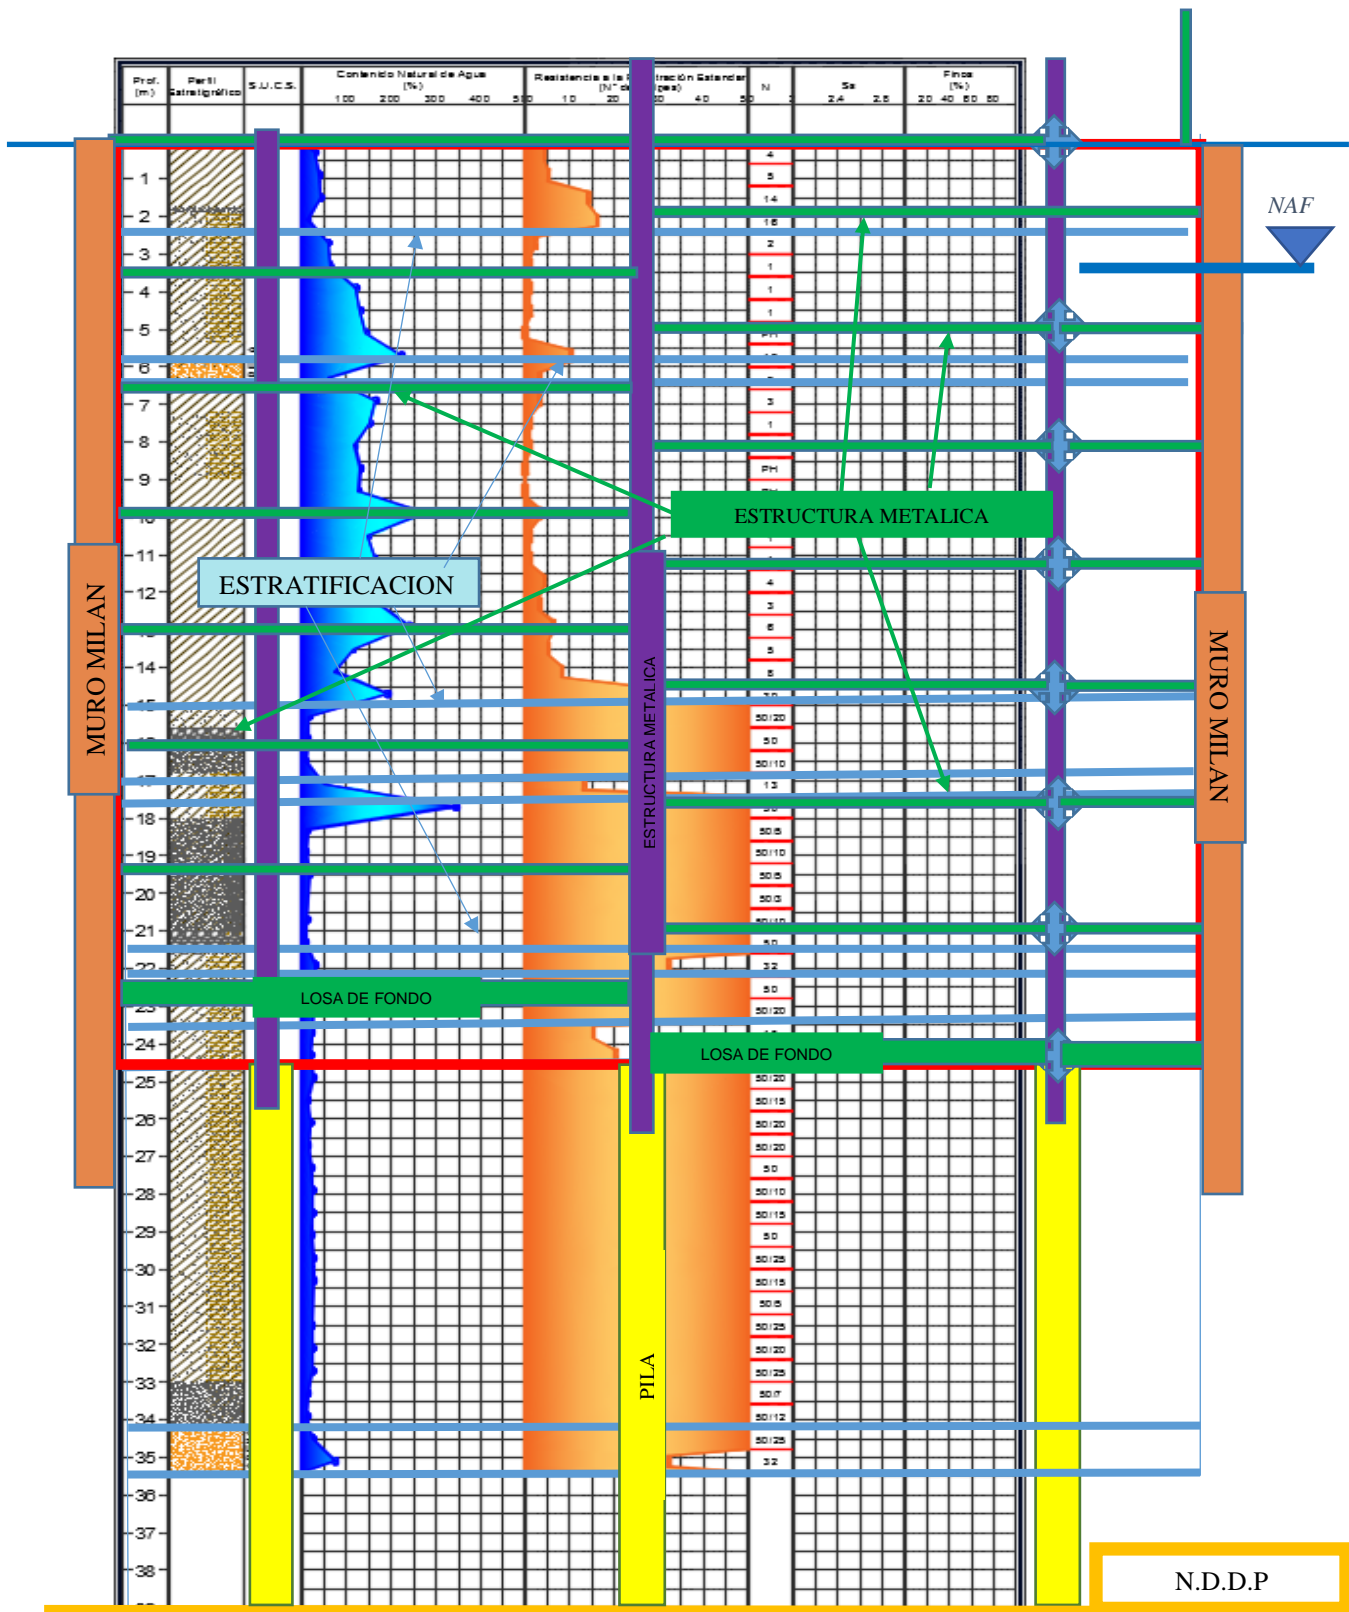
CORTE DE PROYECTO CON PILAS Y PROCESO CONSTRUCTIVO
